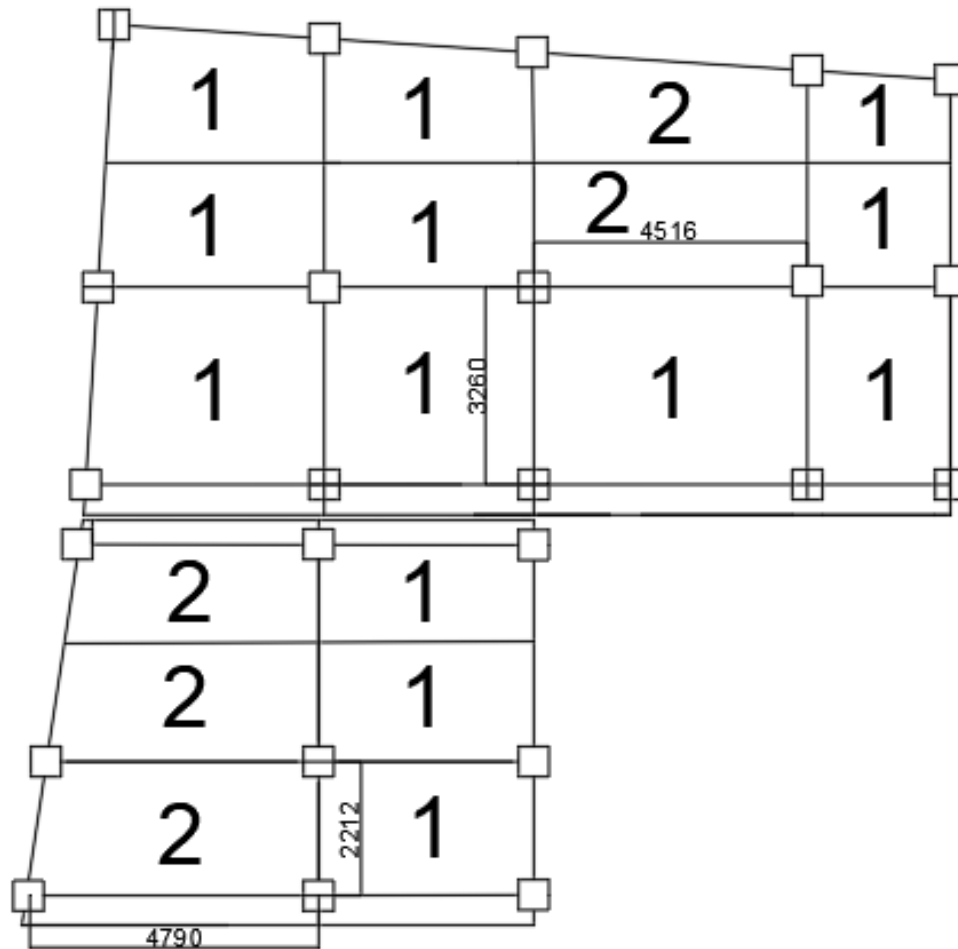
Hasil Desain Pelat Tipe I di Bangunan C
